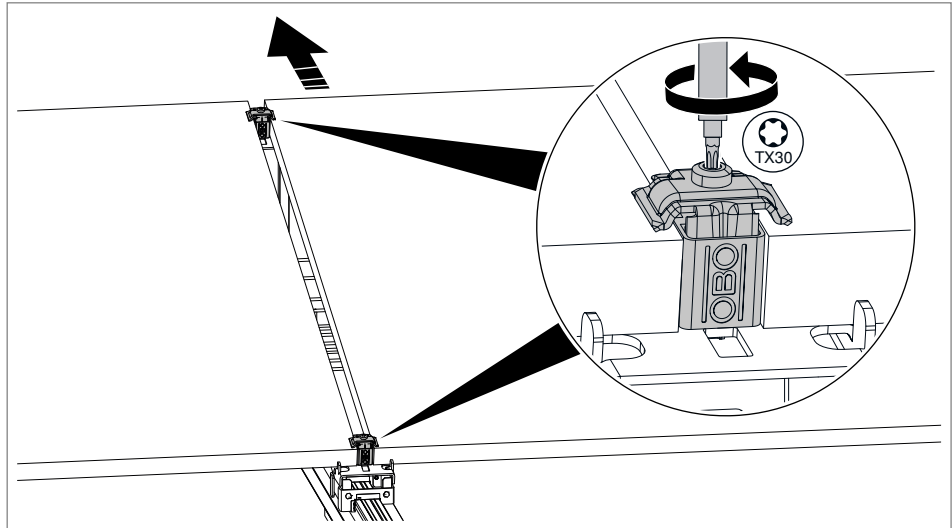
PV-Modul auswechseln, Befestigung seitlich und mittig
